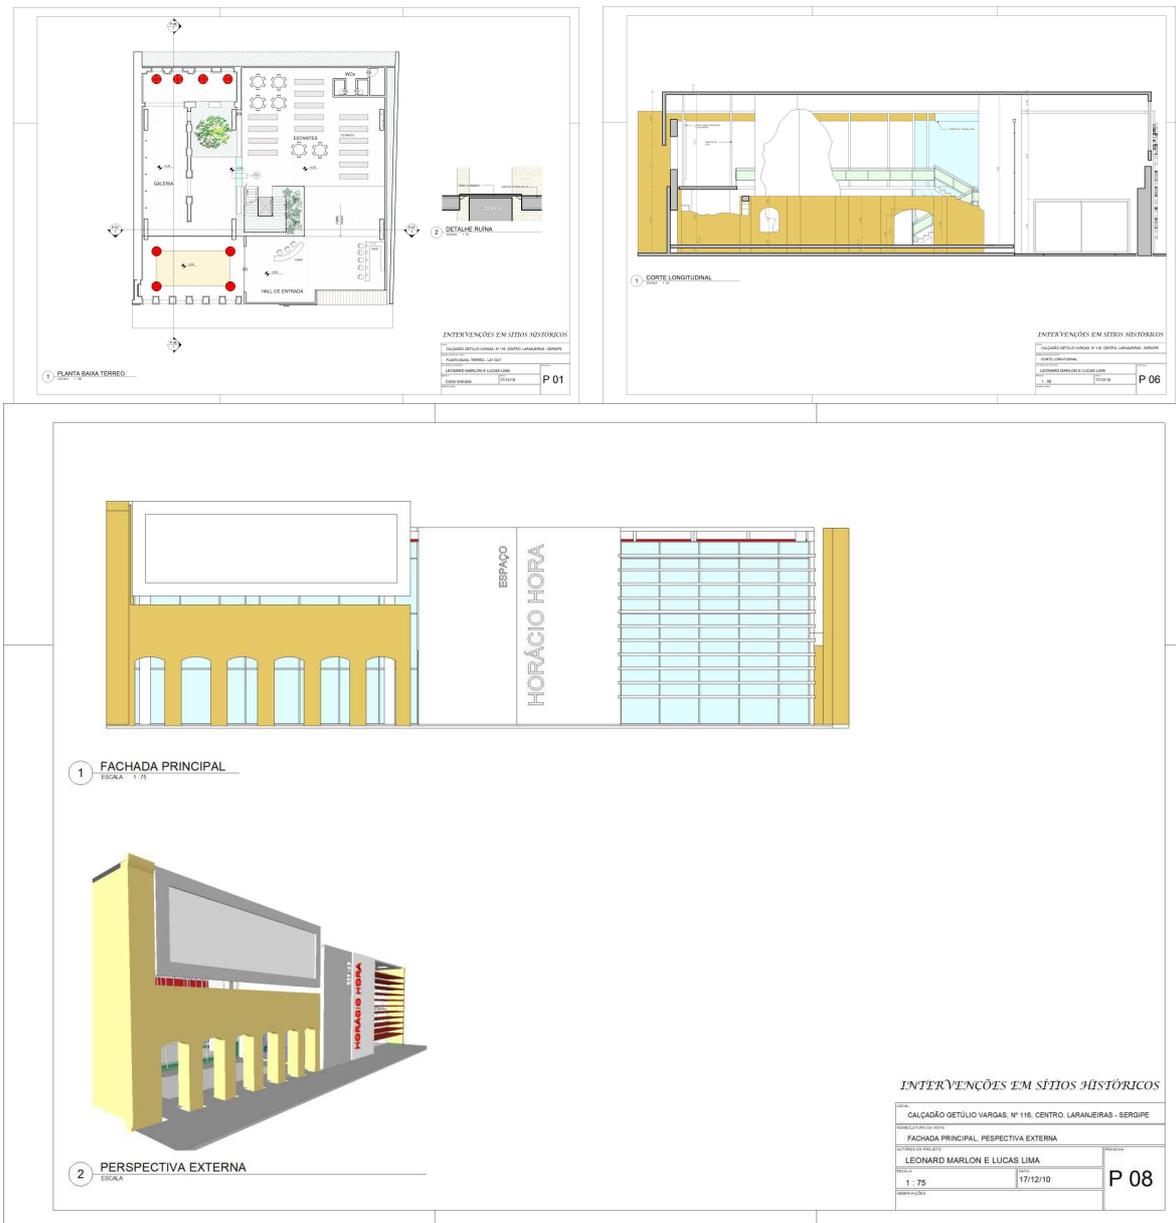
Planta baixa, corte longitudinal, fachada e estudo de volumetria.
